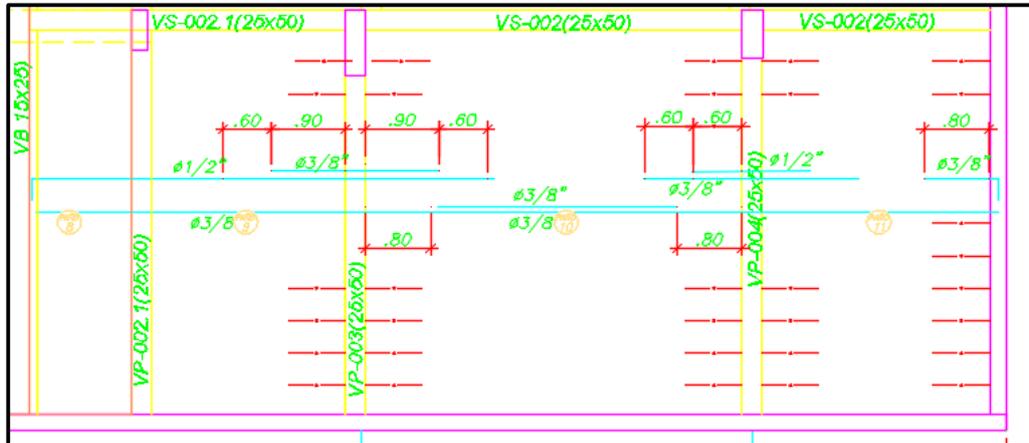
Detalle del sector del plano del sistema de losa aligerada convencional.
